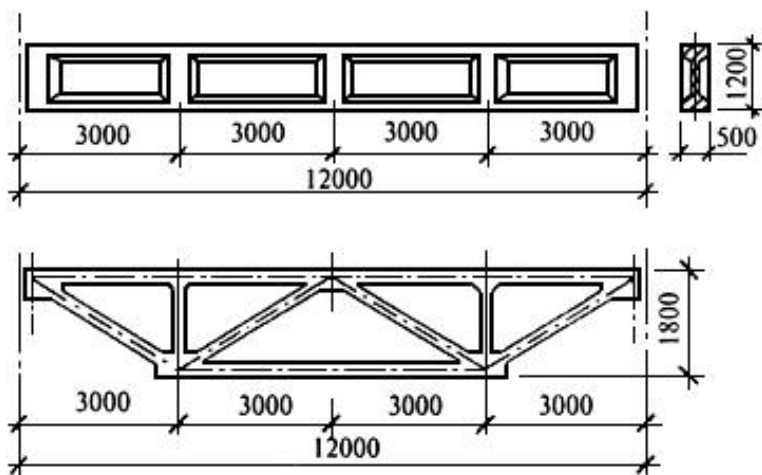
Продольная предварительно напряженная балка и ферма для покрытий из панелей-оболочек КЖС при шаге колонн 12 м
